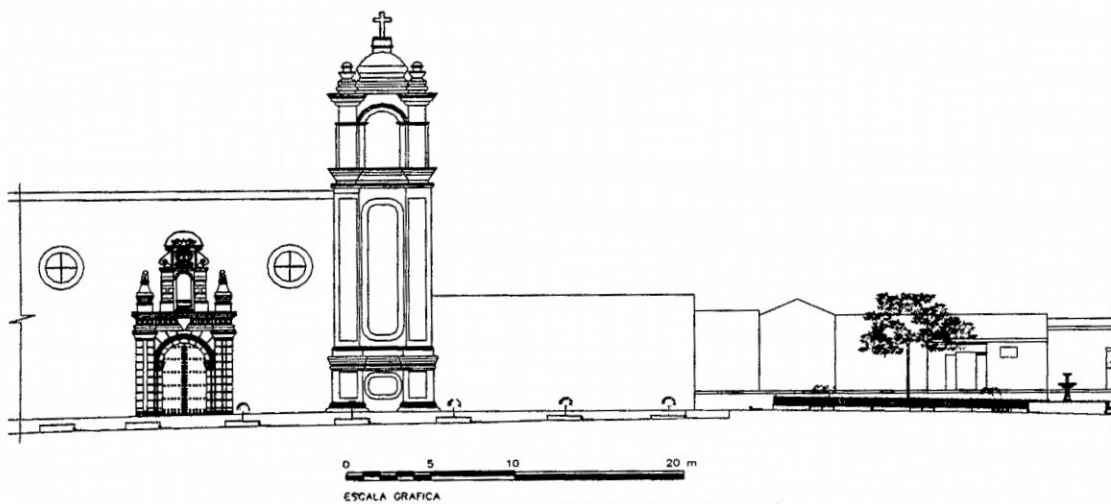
Fachada lateral de la Iglesia Santa Teresa
